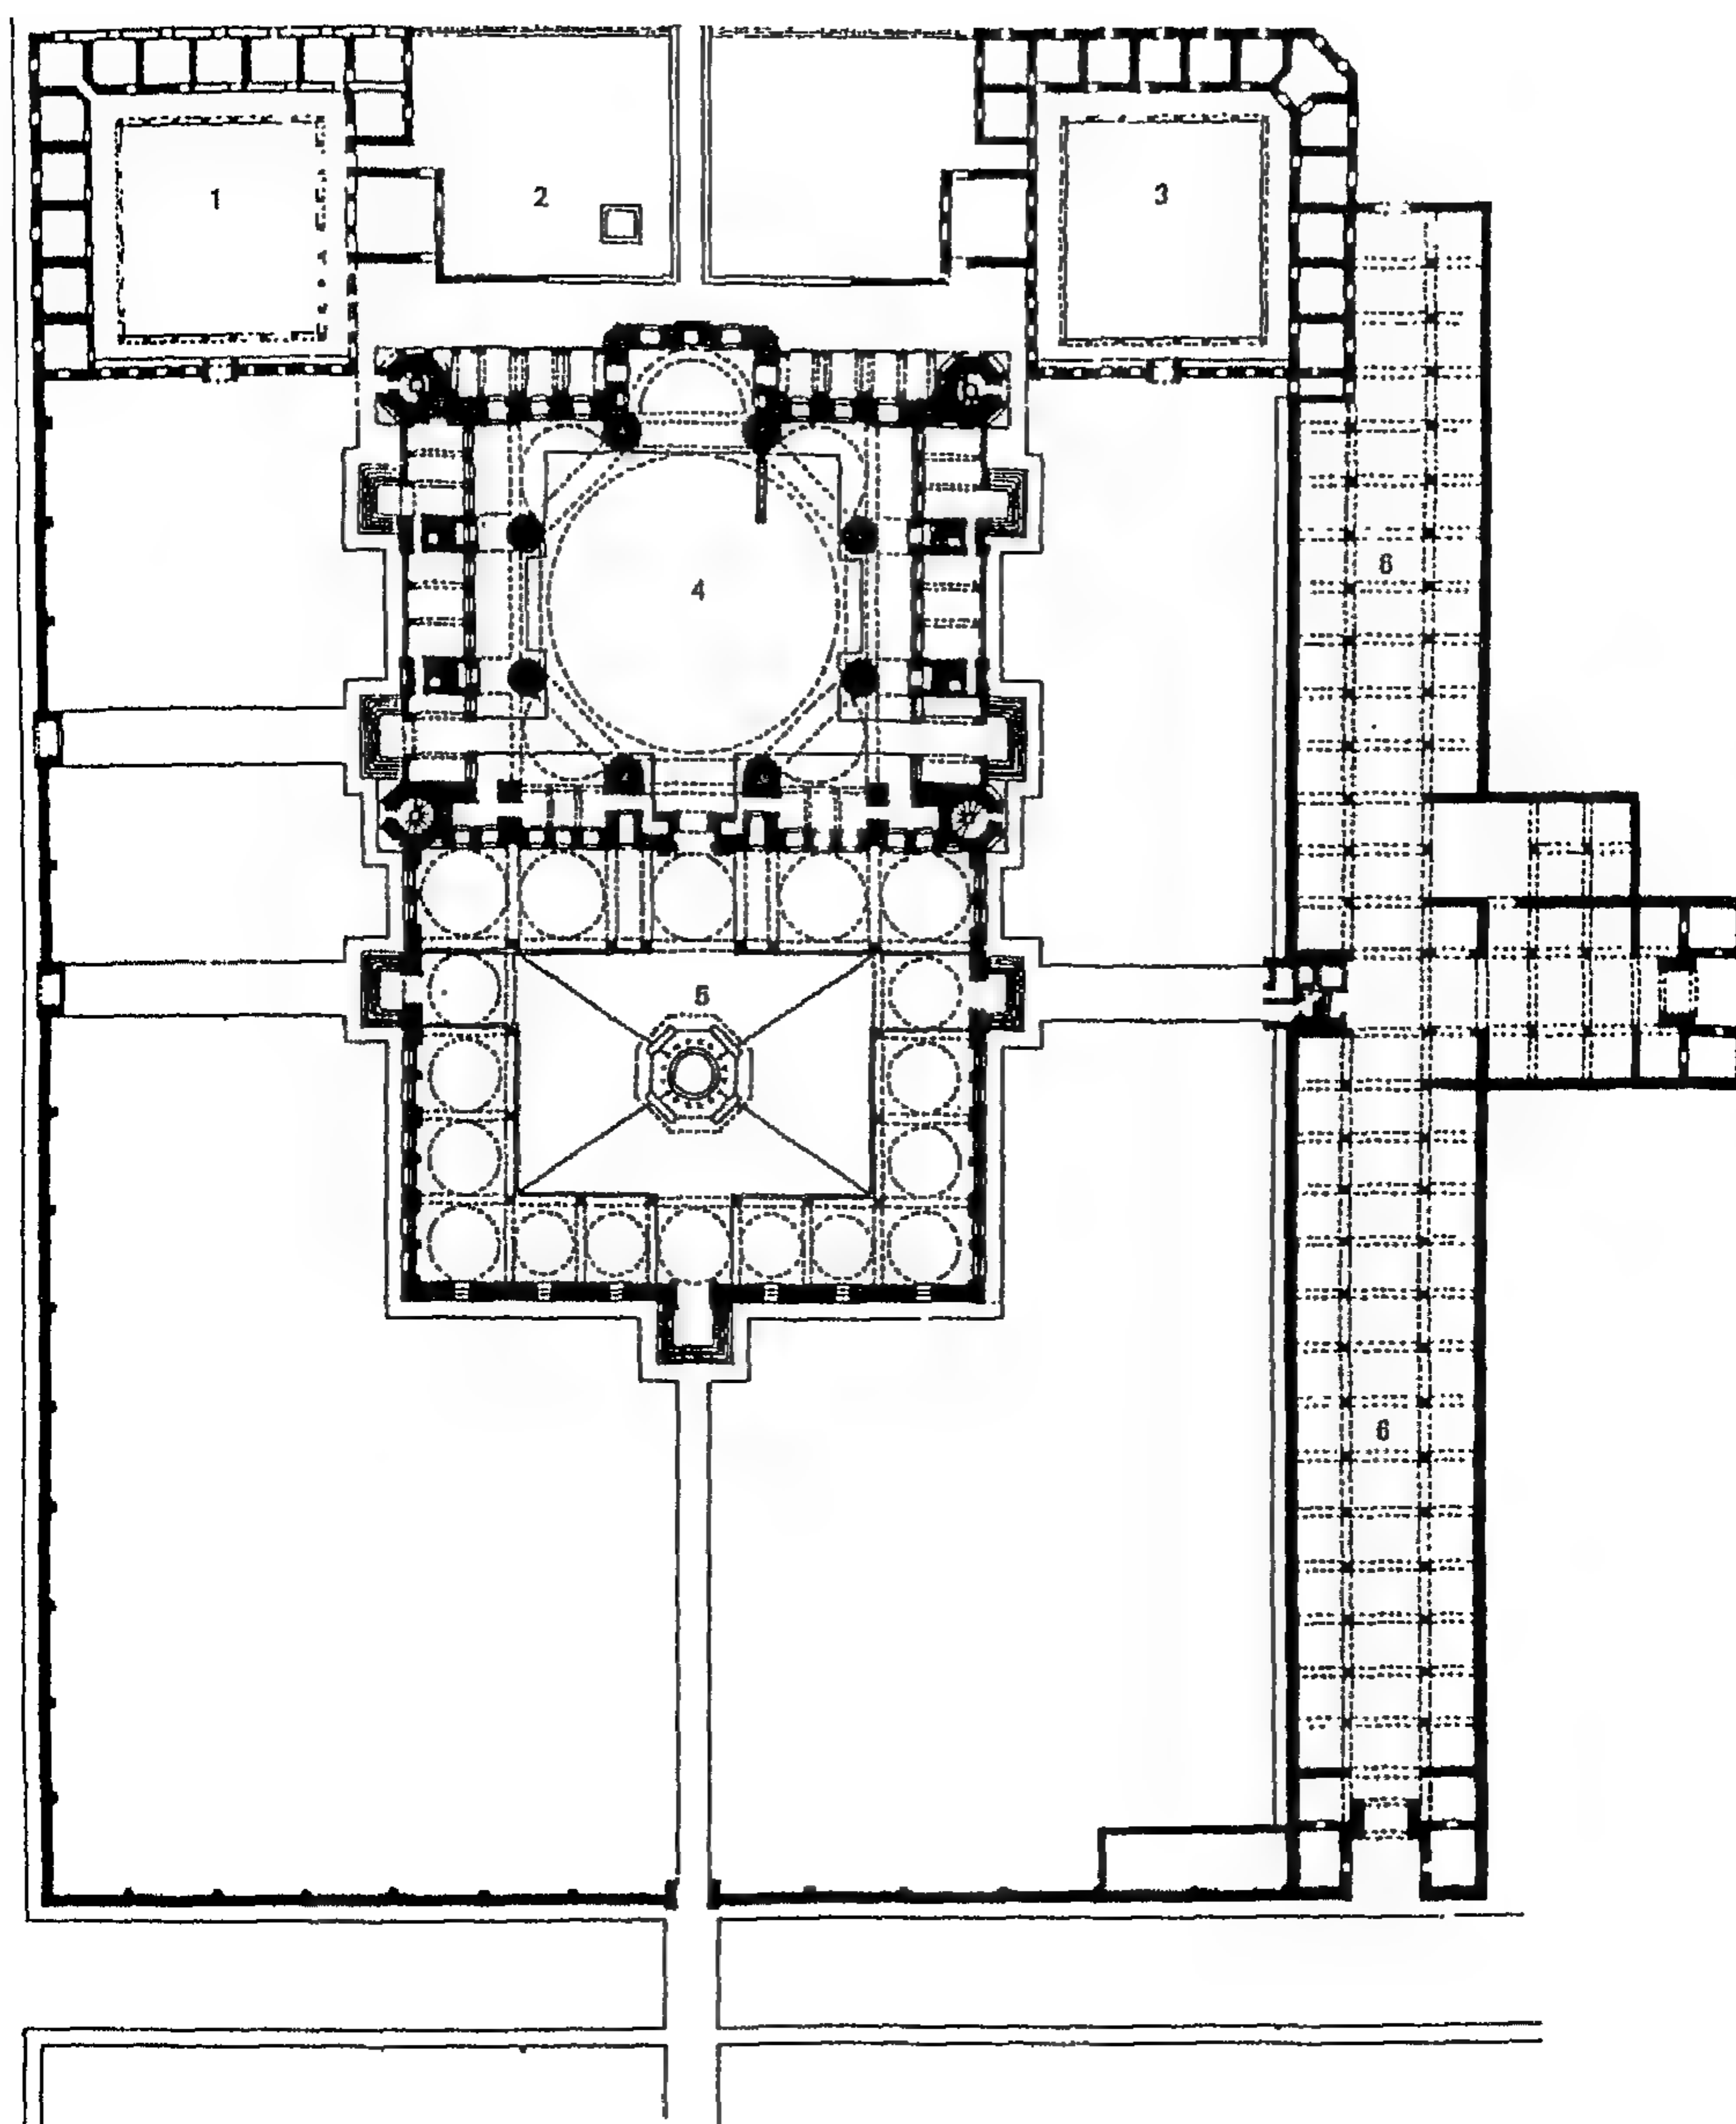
مسقط أفقي لمسجد لاري چلبي في أدرنة (عن : Tüksel).
